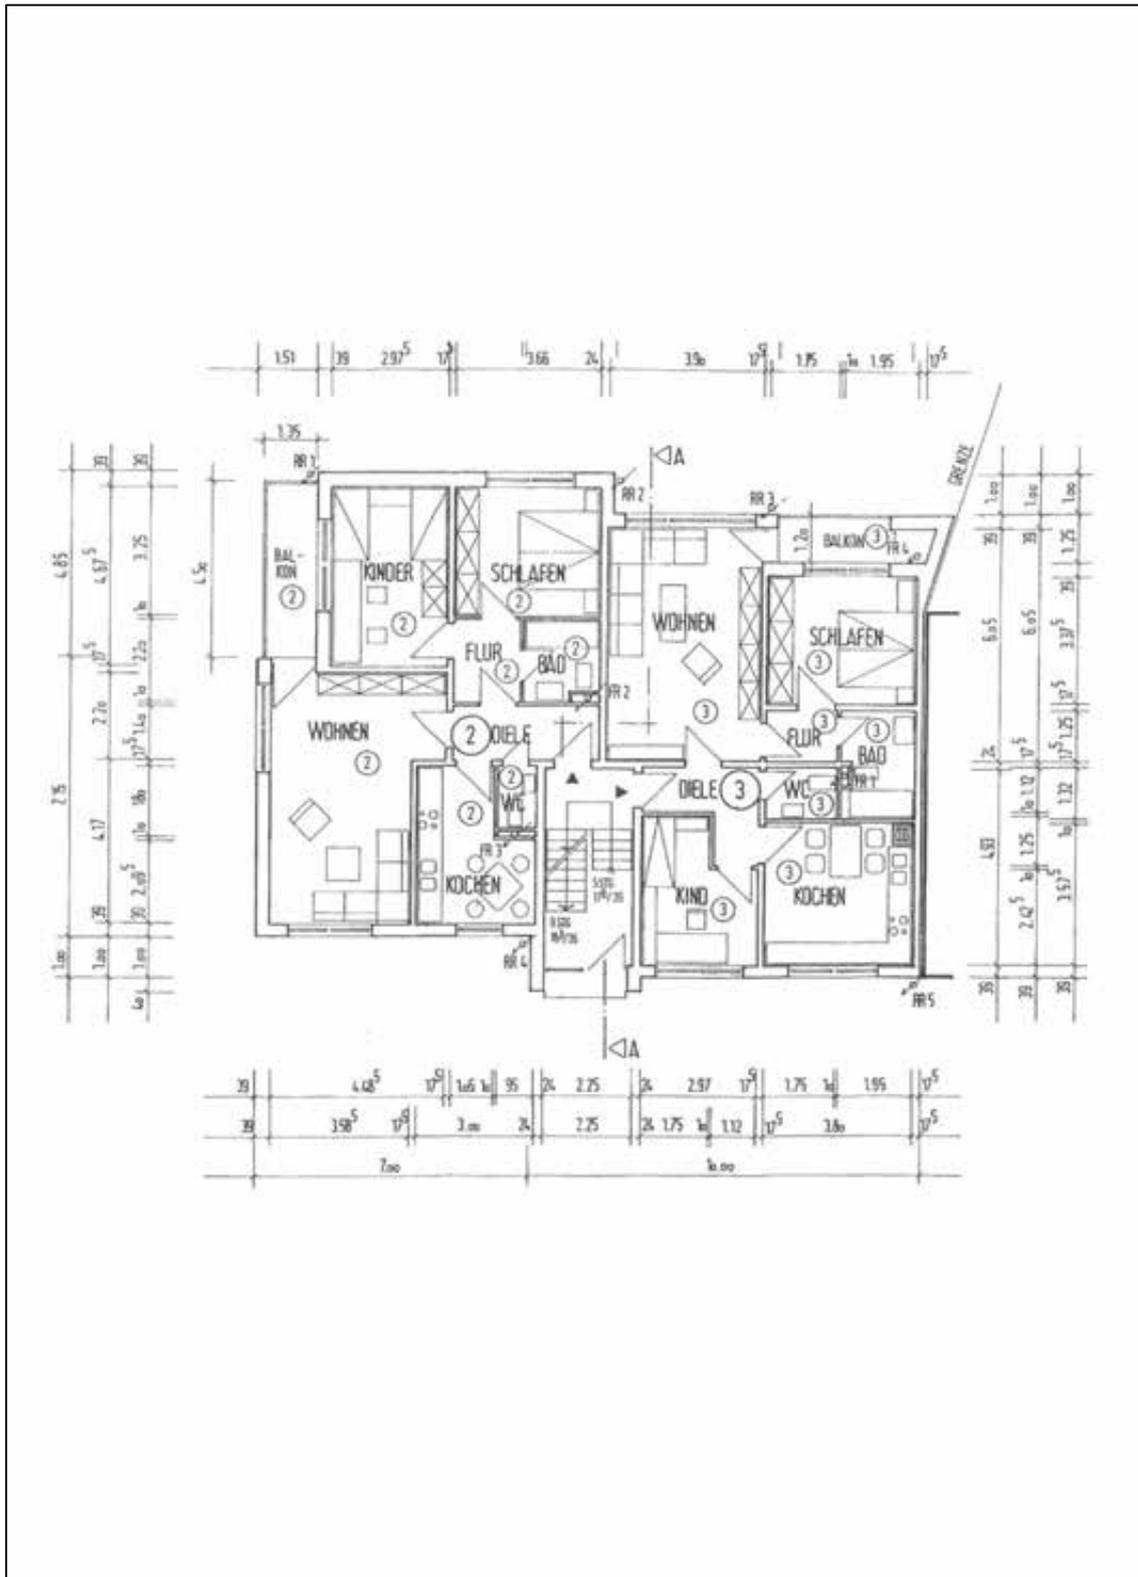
Grundriss vom Erdgeschoss
